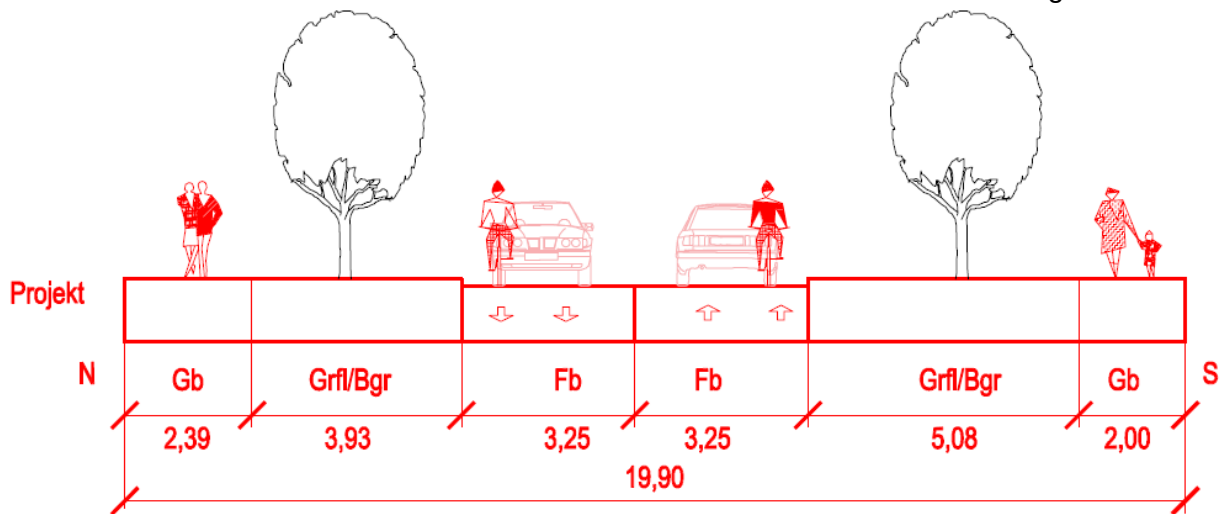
Schematische Darstellung Planung Vorzugsvariante Querschnitt Truderinger Straße zw. Baumkirchner Straße und Schwanhildenbergweg; (Quelle: Ing.-Büro Dr. Zimmermann)
